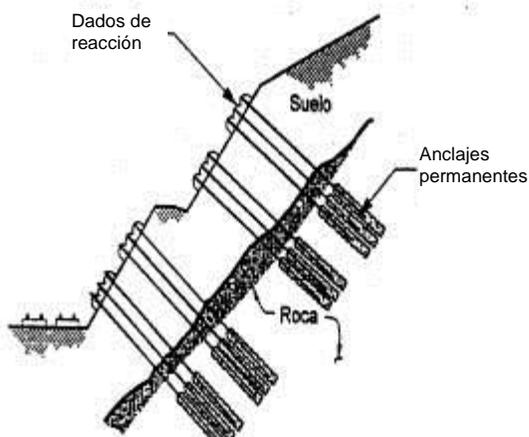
Estabilización de un corte con anclas embebidas en roca.
